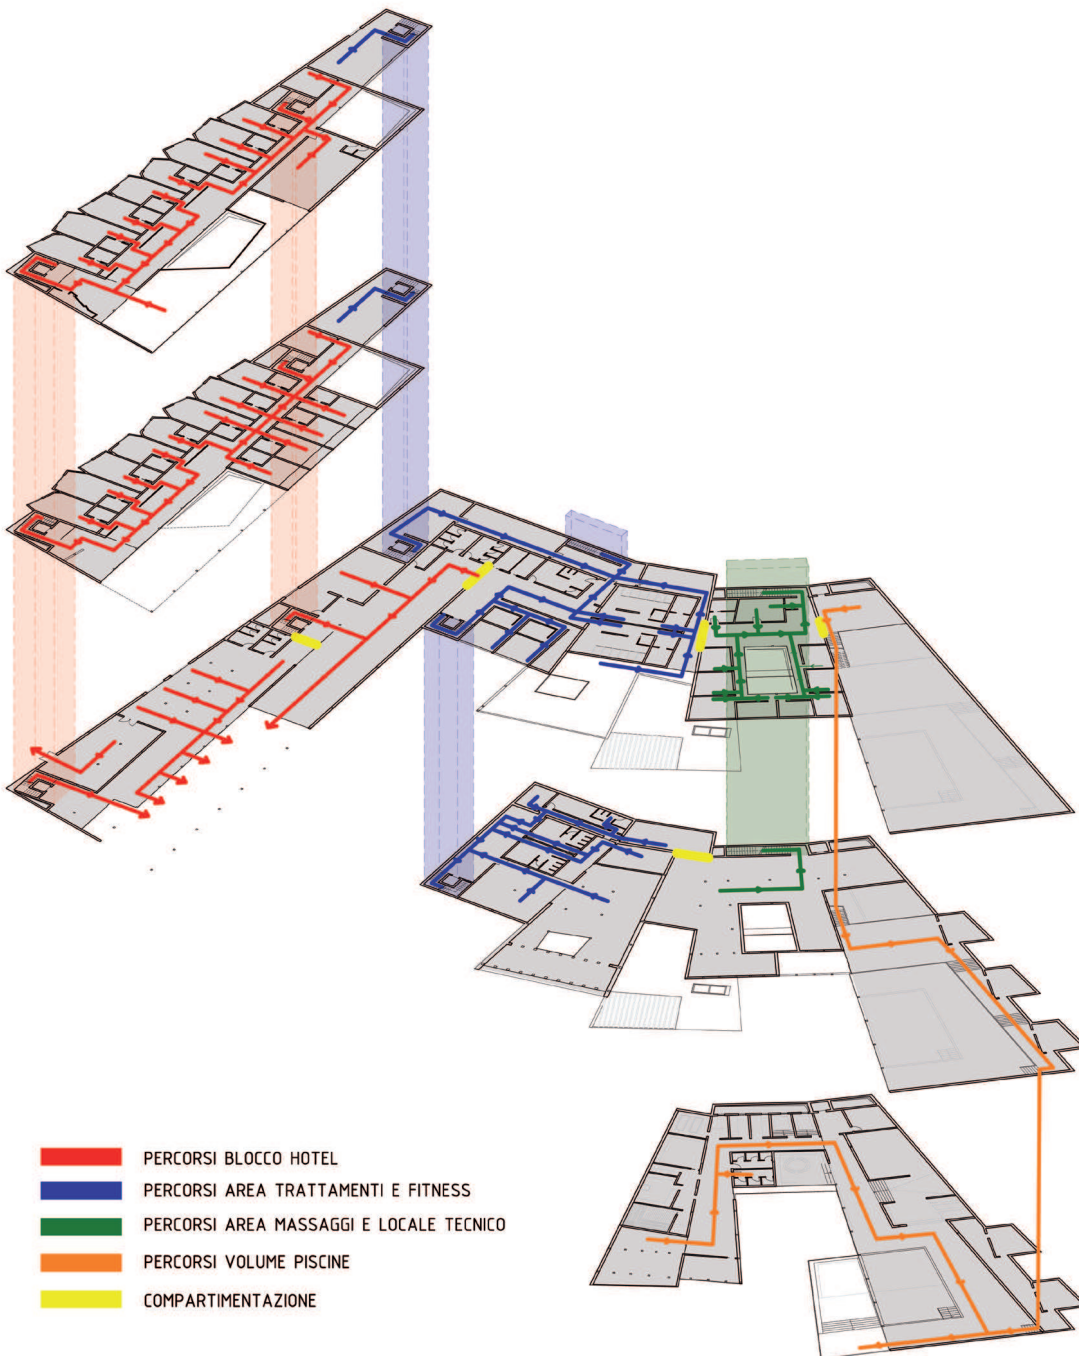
\_Schema di evacuazione: pianta con vie di fuga
